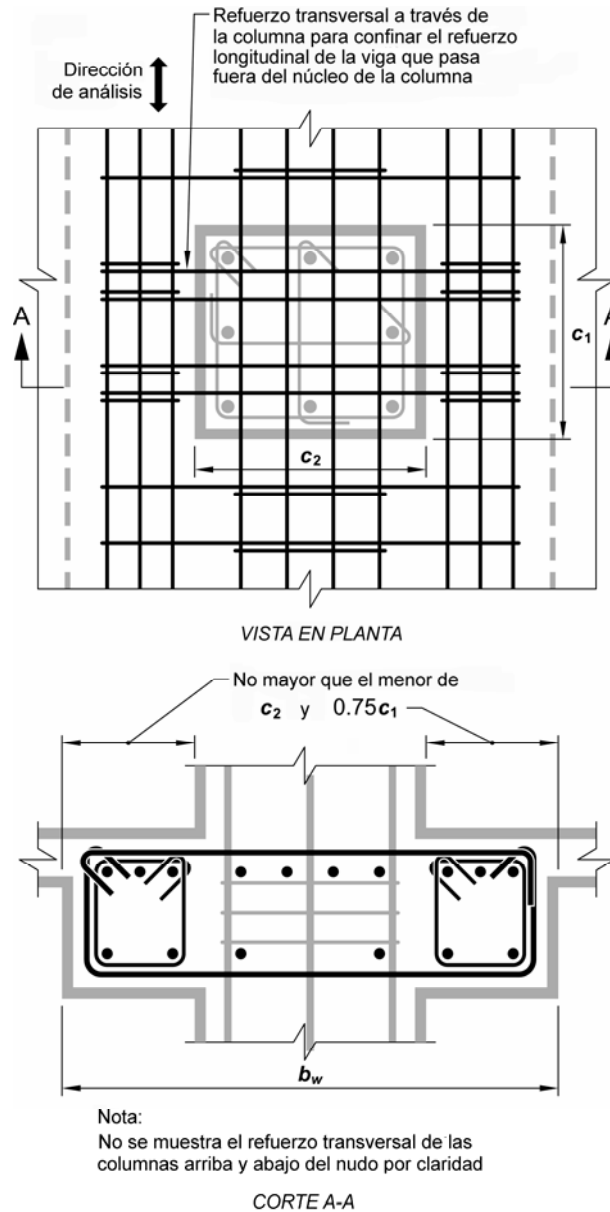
Máximo ancho efectivo de una viga ancha y refuerzo transversal requerido
